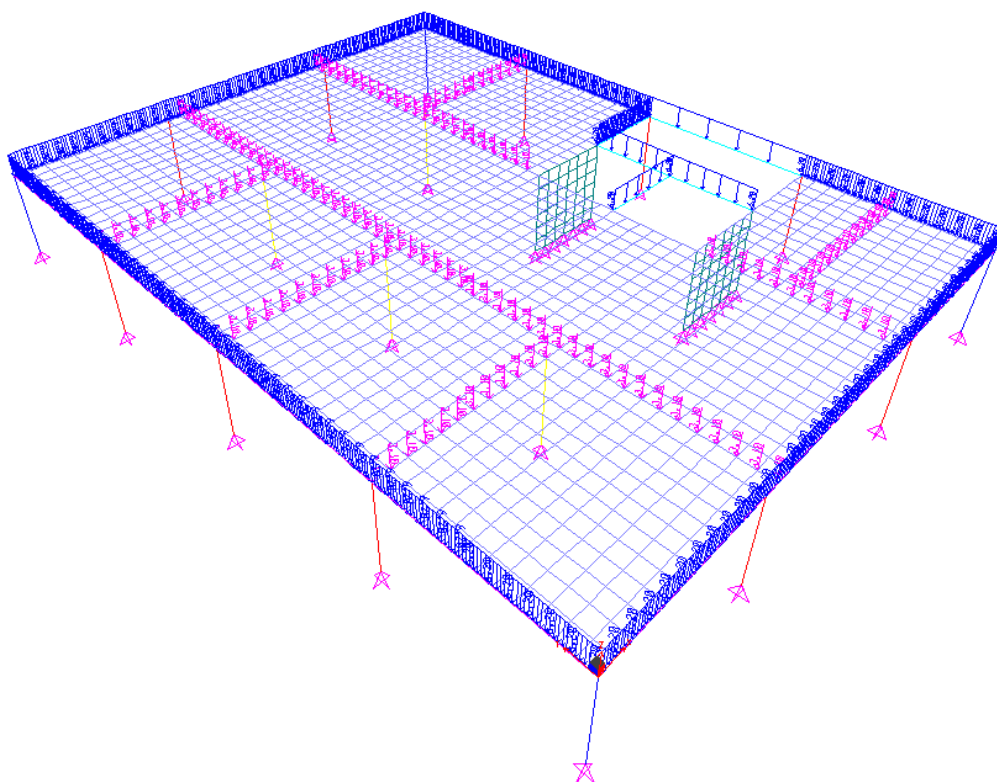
Carregamento de alvenaria aplicado em vigas e na laje lisa via SAP2000
